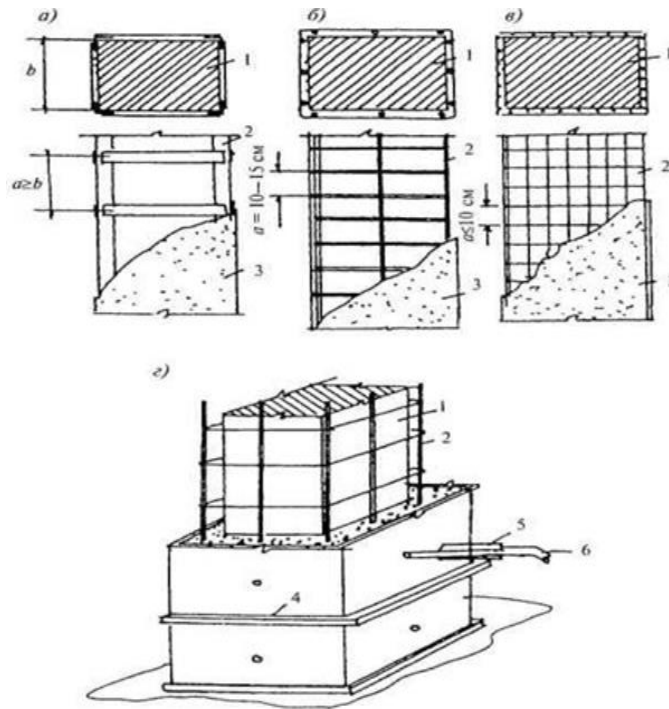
Посилення стовпів сталевую обоймою(а), армокаркасами(б), сітками і залізобетонними обоймами(у, з) 1 - посилювана конструкція; 2 - елементи посилення; 3 - захисний шар; 4 - щитова опалубка з хомутами; 5 - ін'єктор; 6 - матеріальний шланг.
